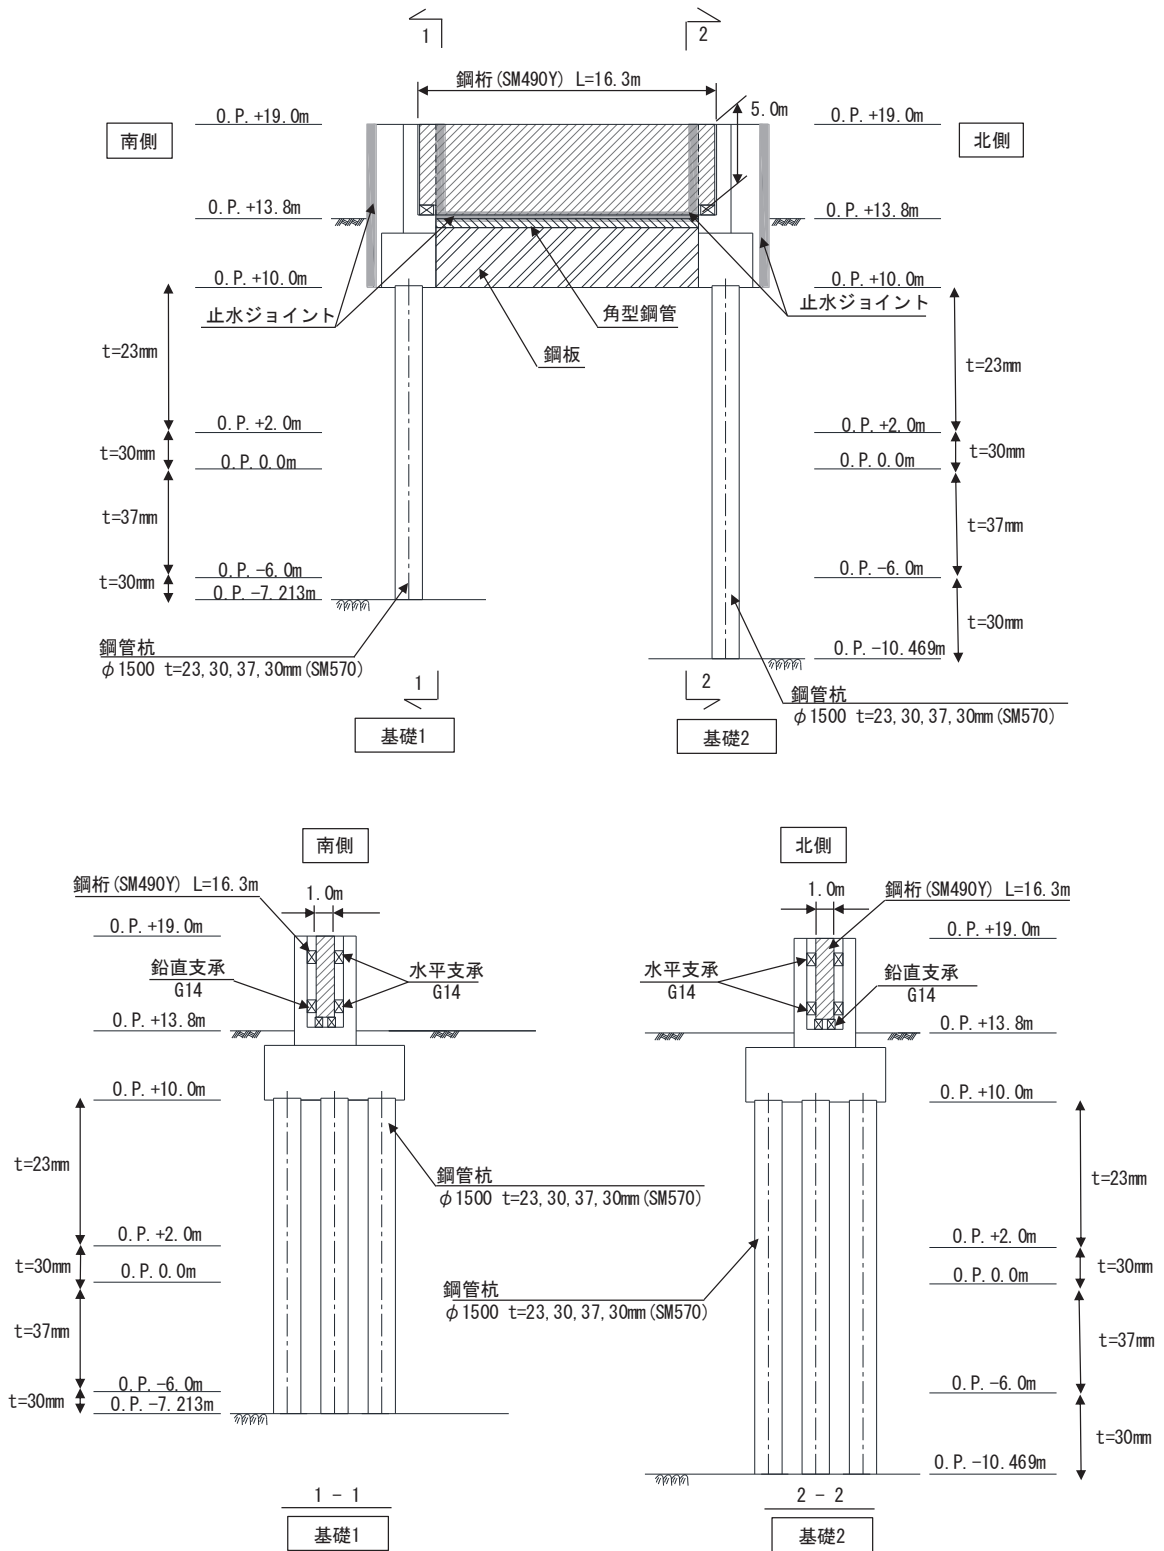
鋼製遮水壁（鋼桁 5） 正面図及び断面図
